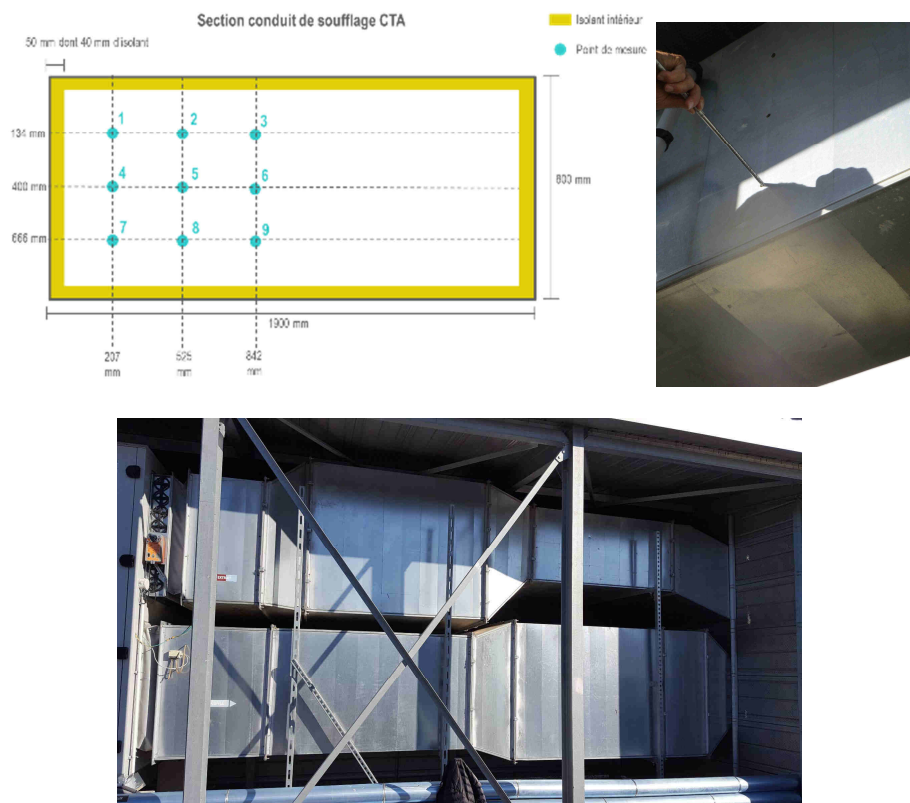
Plan de mesure au soufflage sur le bâtiment 2
